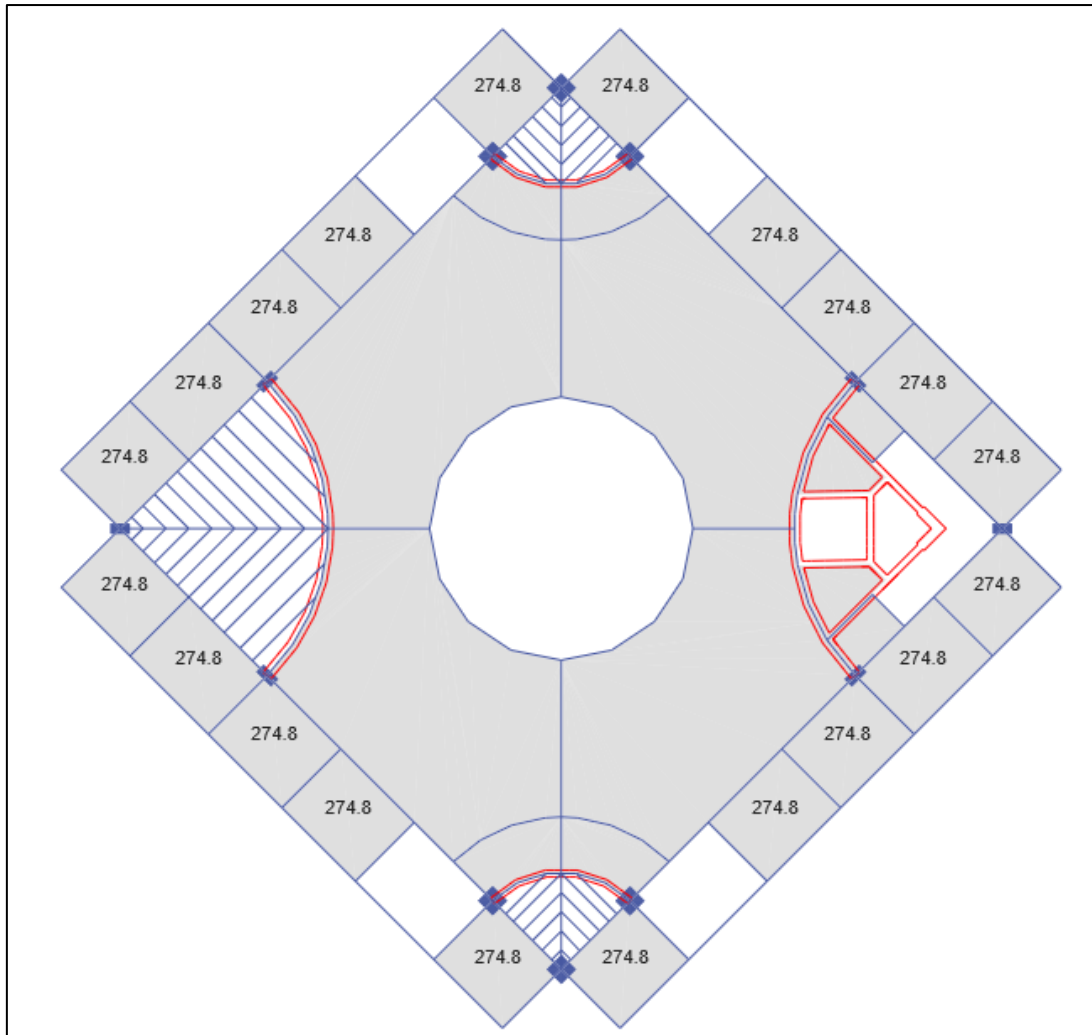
Cargas No Estructurales 1er Piso - Aleros (kg/m²)
